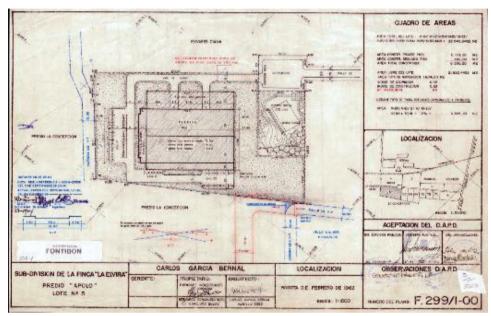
Plano Urbanístico F 299/1-00 Fuente: Planoteca de la SDP.
